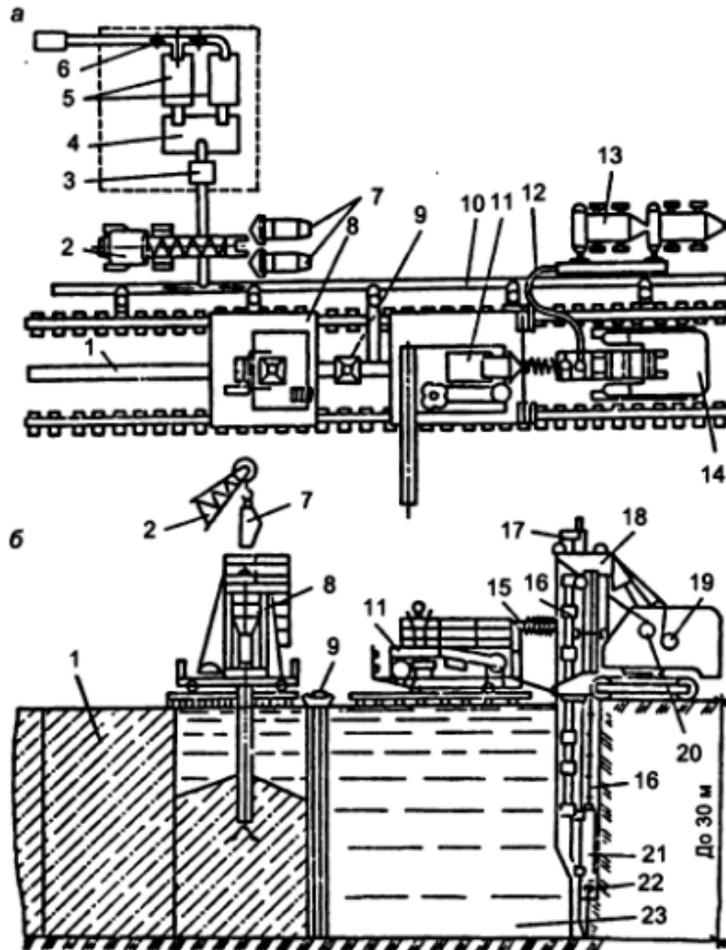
Схемы расположения оборудования (а) и производства работ при устройстве стен сооружения способом «стена в грунте» (б):
